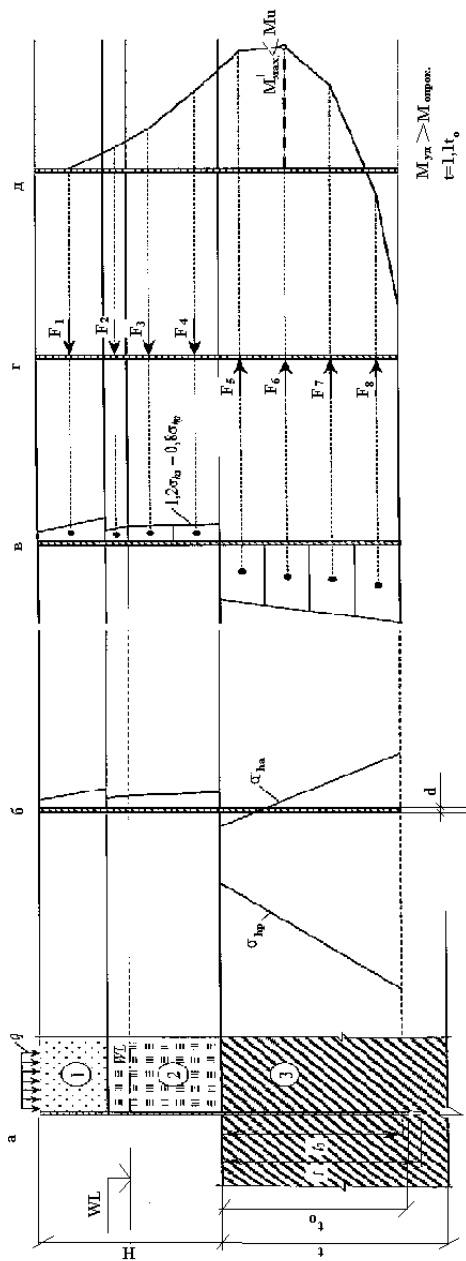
Расчет гибкой консольной (шпунтовой) стены по способу упругой линии:
